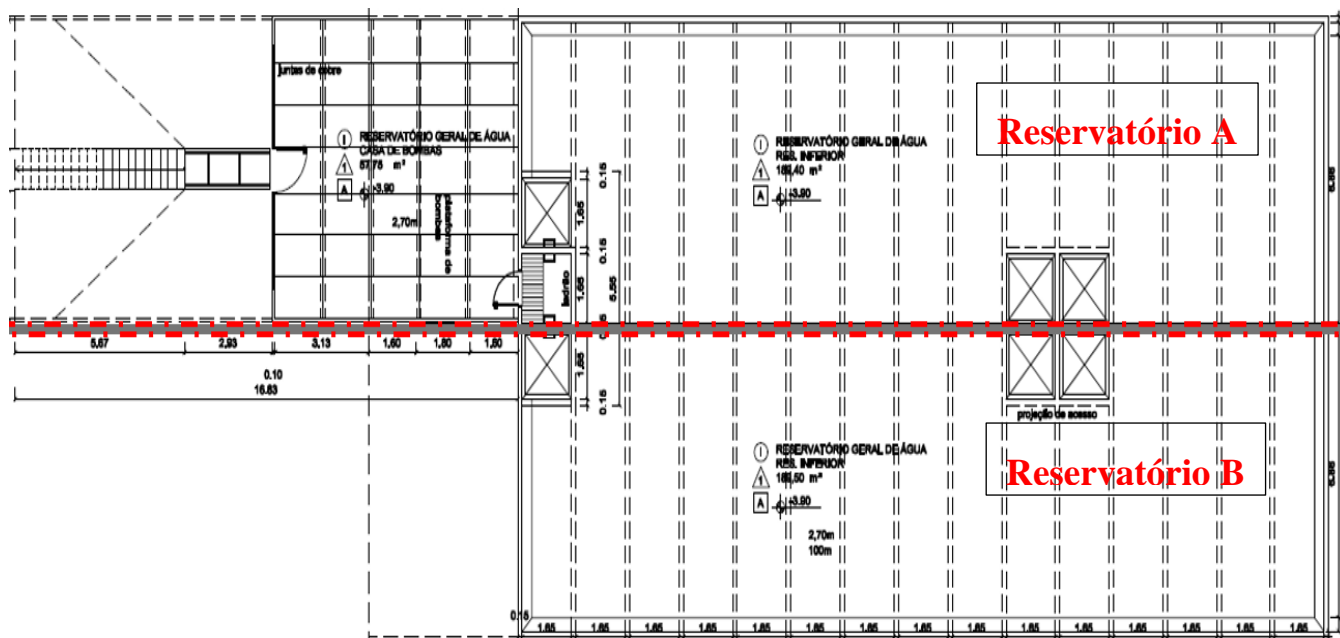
Reservatório inferior em planta dividido em câmaras
